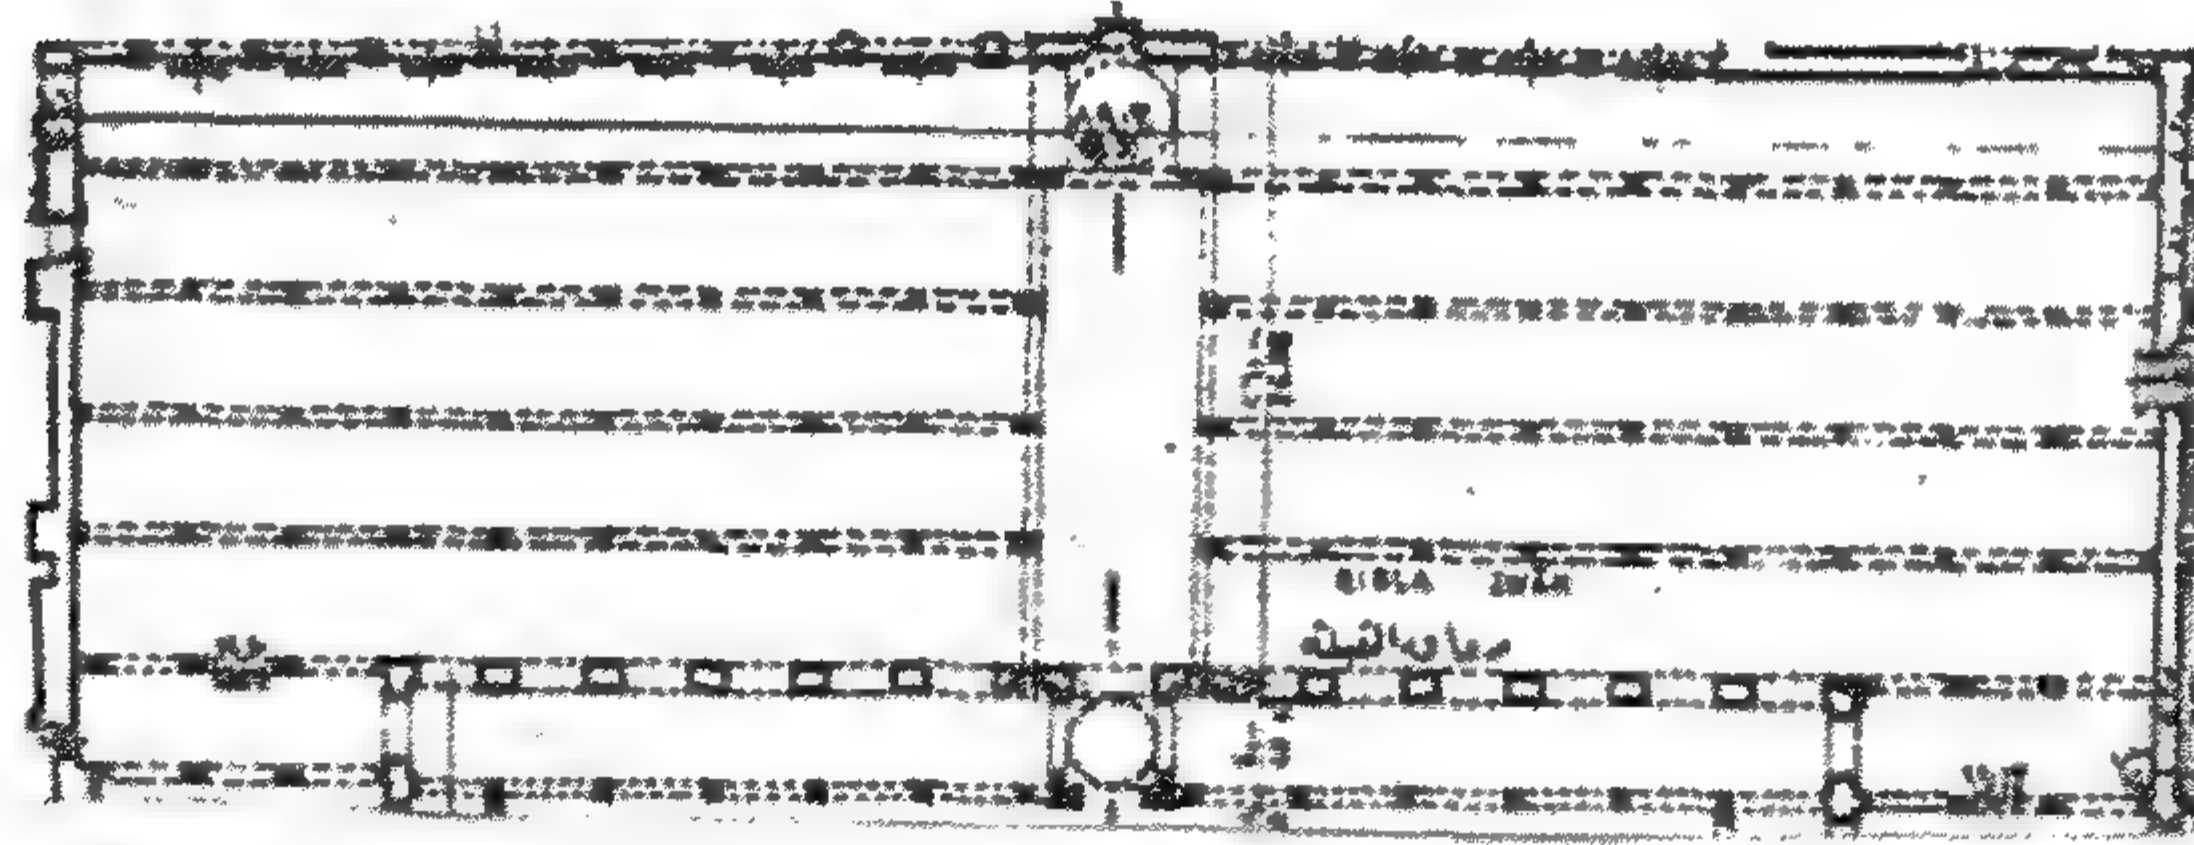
مسقط أفقي لظلة قبلة جامع القيروان ( عن نجوى عثمان )
